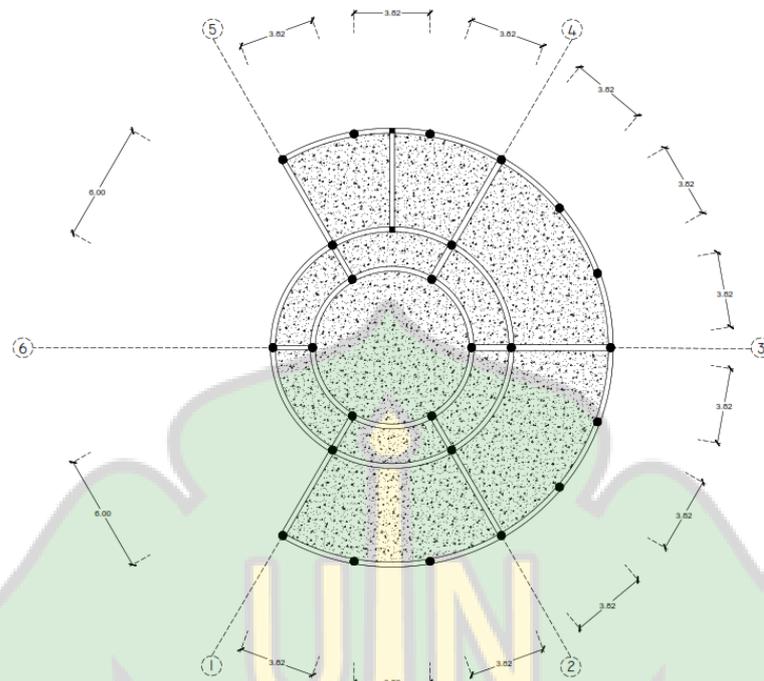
Denah Kolom Lantai 3 Lobby dan Pengelola
